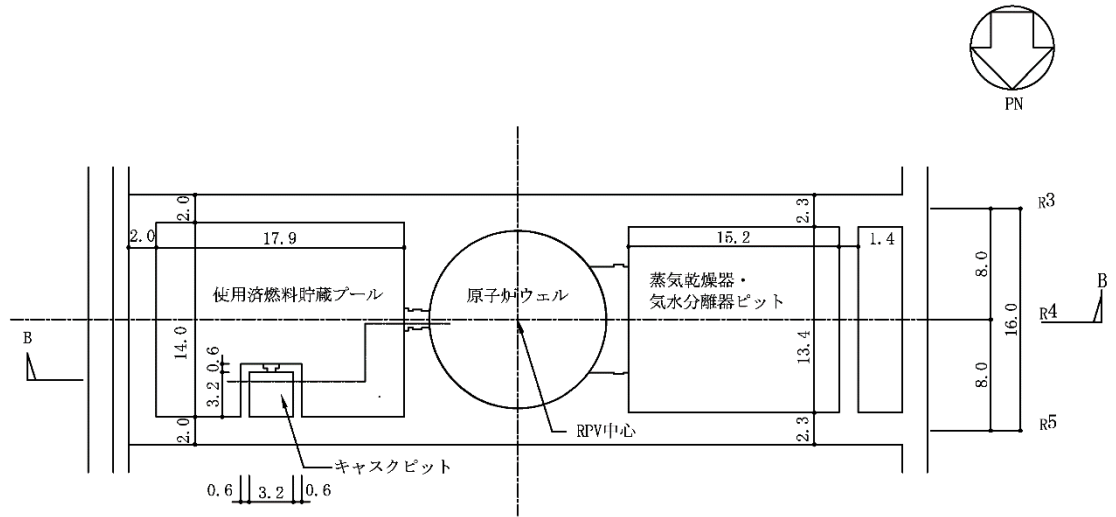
使用済燃料貯蔵プール周りの概略平面図 (単位 : m)
